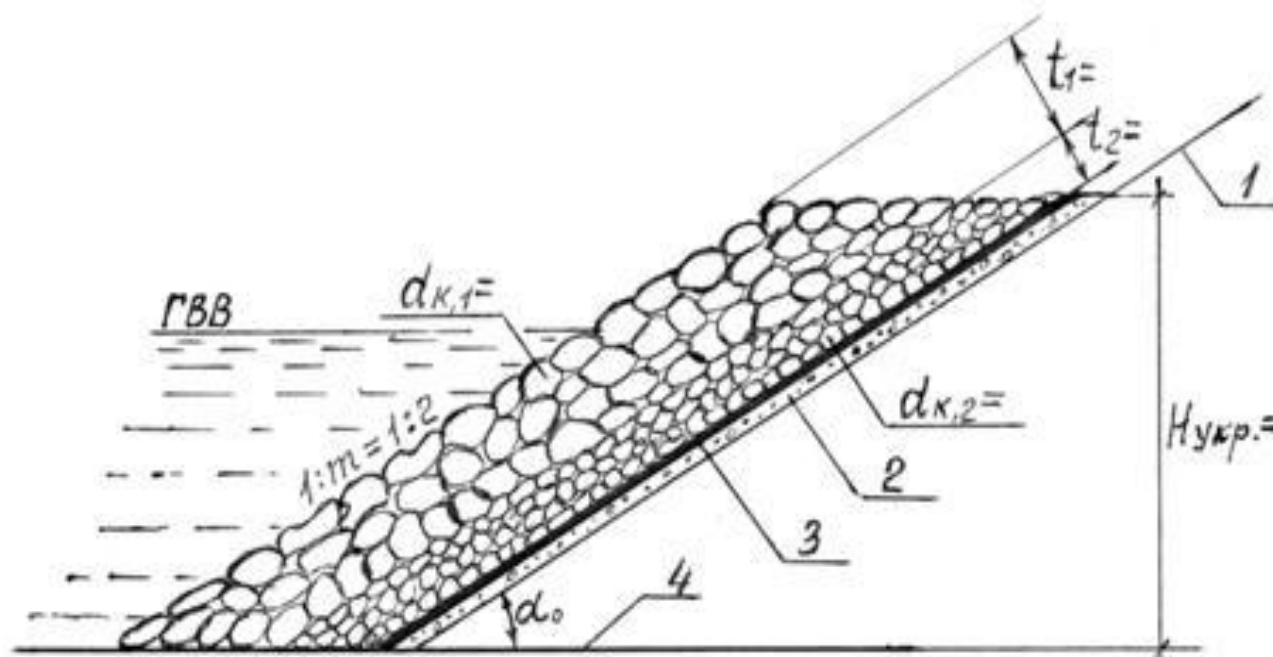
Укрепление откоса насыпи двухслойной каменной наброской при неразмываемых грунтах основания: 1 – откос насыпи или бермы; 2 – выравнивающая подготовка из пескогравия слоем 10–15 см; 3 – обратный фильтр из геотекстиля; 4 – поверхность основания насыпи
